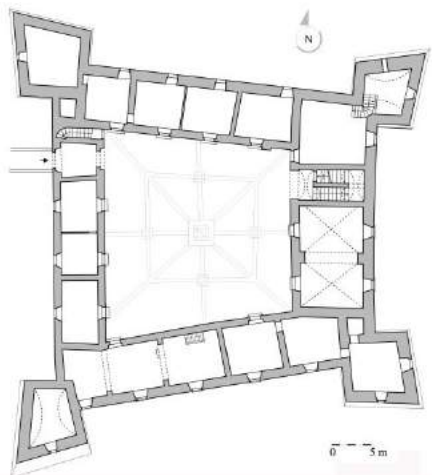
Monasterace (RC). Planimetria del Castello, piano terra [rilievo V. De Nittis].
